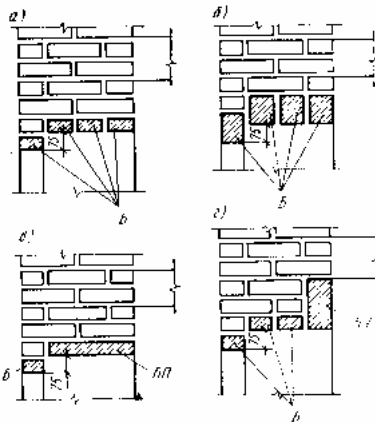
Збірні залізобетонні перемички: а, б – брусккові (тип Б); в – плитні (тип БП); г – балкові (тип БУ)
